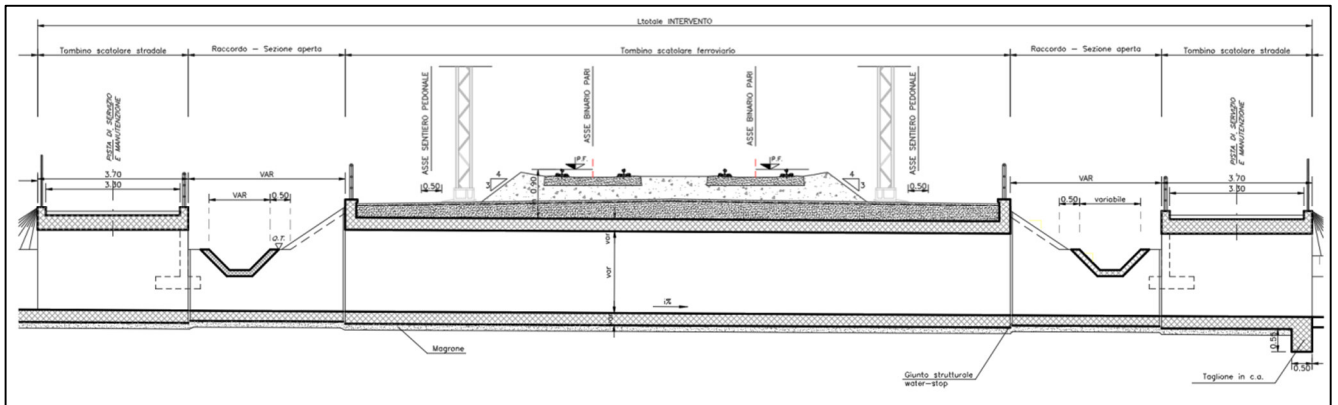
Attraversamenti idraulici – sezione longitudinale tipo
